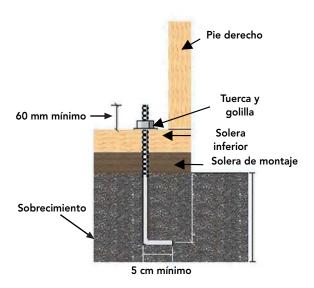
43 : Detalle de la barra de acero hilado que ancla la estructura del tabique soportante al sobrecimiento o viga de fundación
